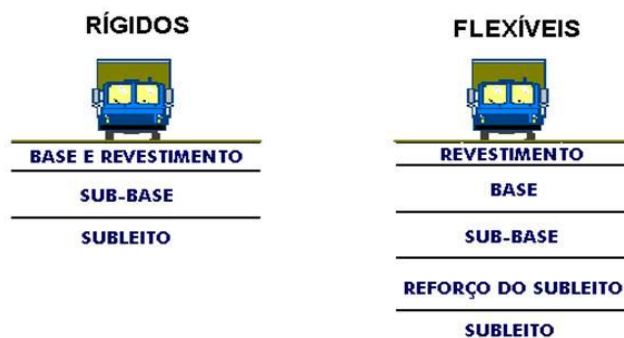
Representação esquemática das estruturas dos pavimentos, rígido e flexível.
